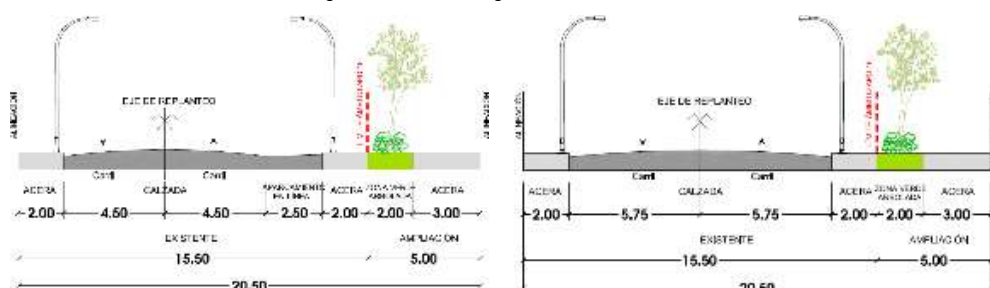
Nuevas secciones tipo de la calle Sauce. A la izquierda, tramo Sur donde existe aparcamiento, a la derecha, tramo Norte donde no existe aparcamiento en la actualidad
